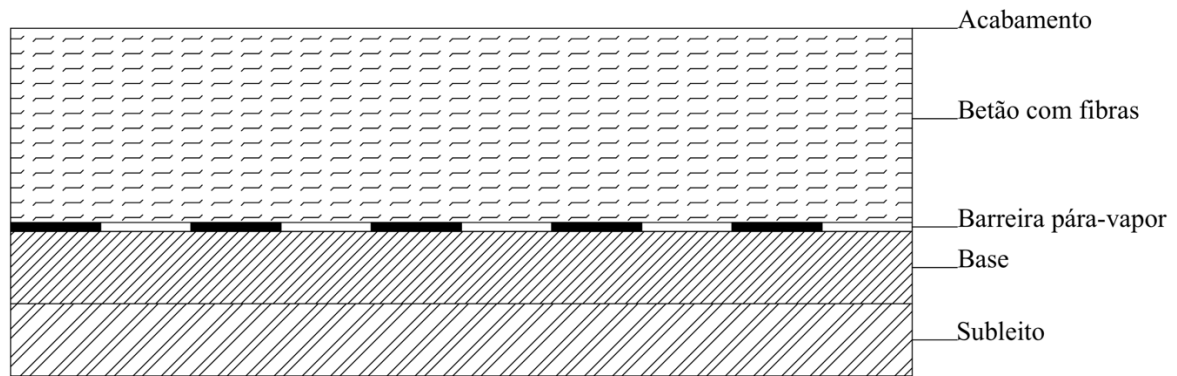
Pavimento de betão reforçado com fibras [adaptado 34]
